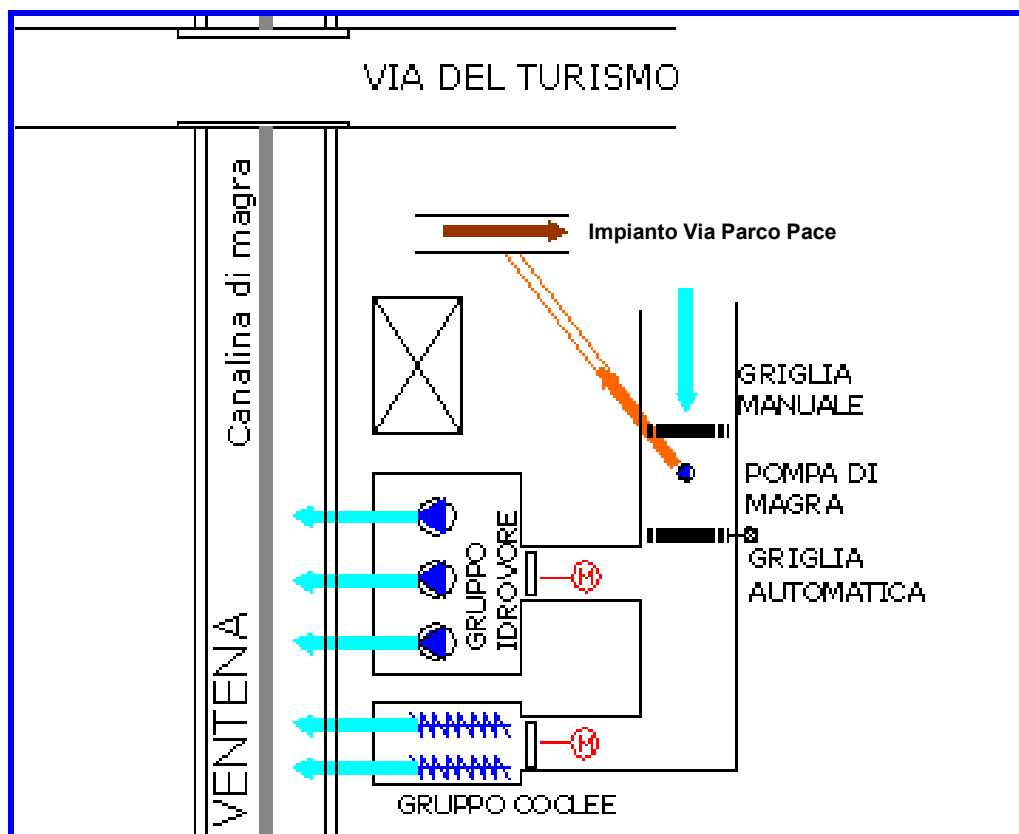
Schema dell'impianto di sollevamento Ventena.
